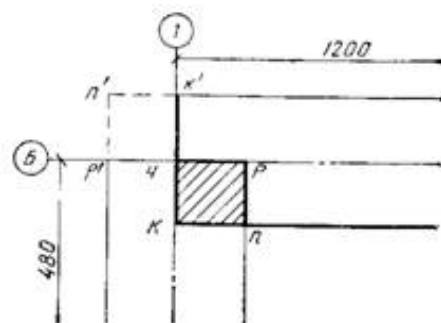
Фрагмент плана траншеи под фундаменты здания со взаимно пересекающимися осями
